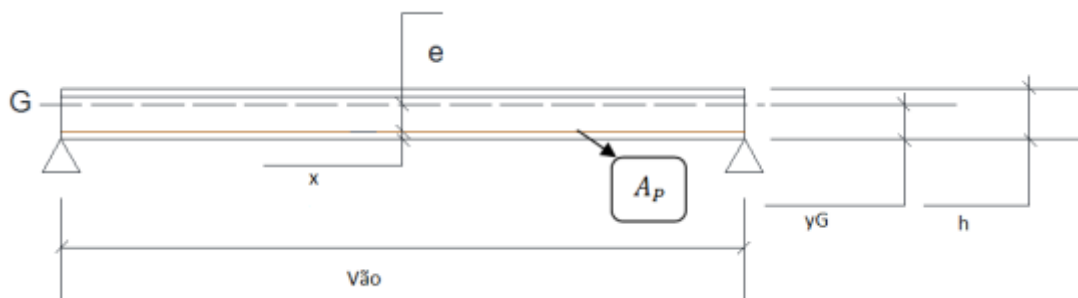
Laje Duplo T - Corte Longitudinal – Disposição retilínea de A_p em elementos pré-fabricados
